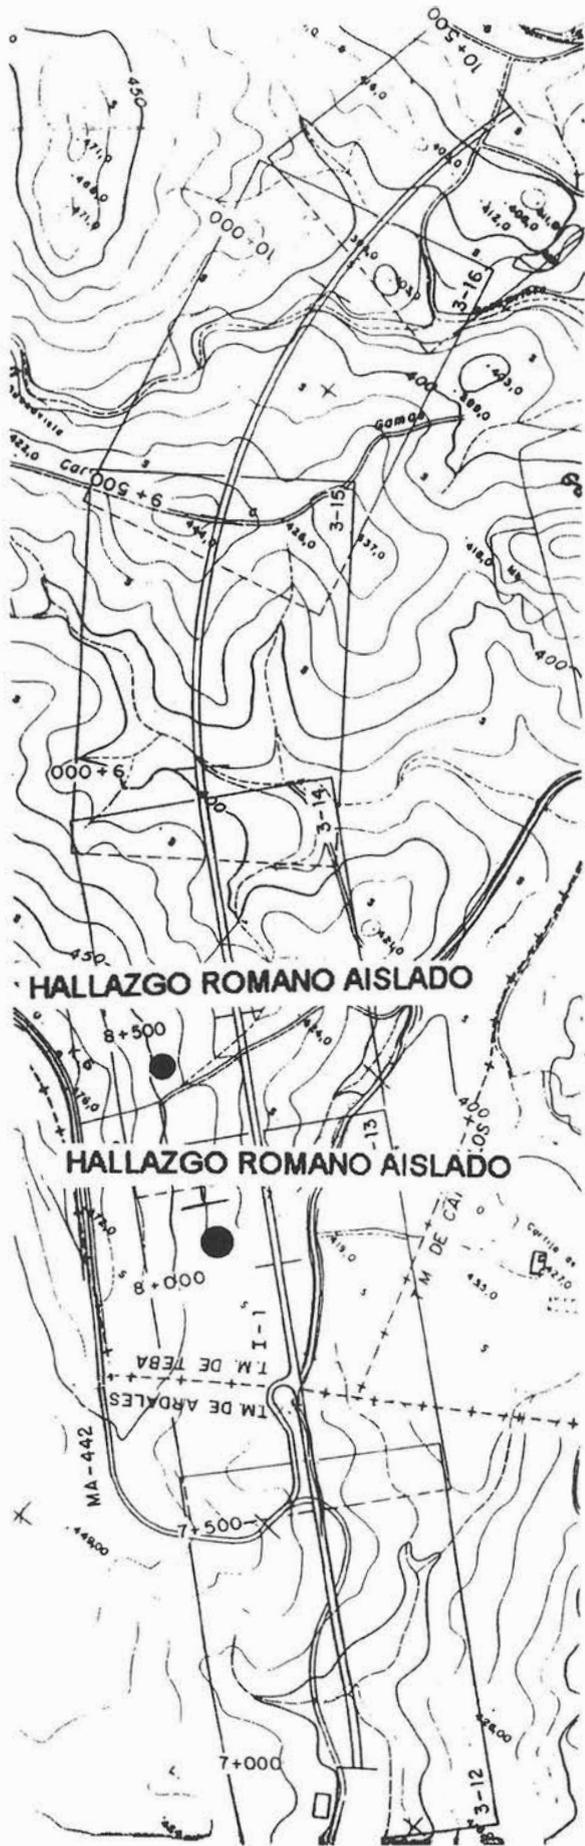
Planta y sección de la traza con ubicación de hallazgos aislados.
